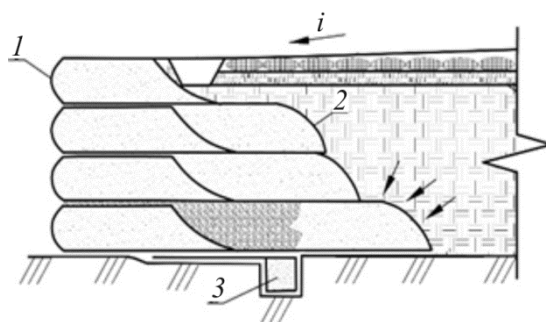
Грунтонаполняемое подпорное сооружение для транспортных систем: 1 – грунтонаполняемый лицевой блок-оболочка; 2 – грунтонаполняемый внутренний блок-оболочка; 3 – дренажное устройство
